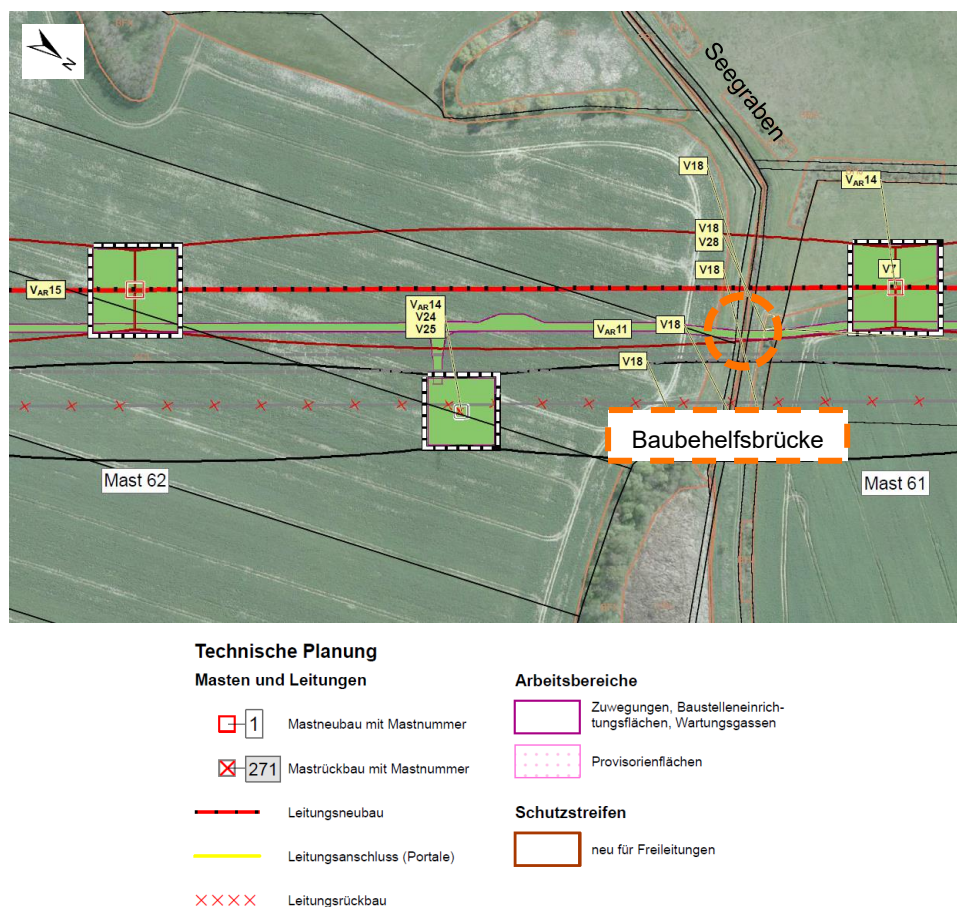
Ausschnitt aus LBP-Maßnahmenlageplan (Unterlage 7, Anhang 4, Blatt 24/60), Position Baubehelfsbrücke
